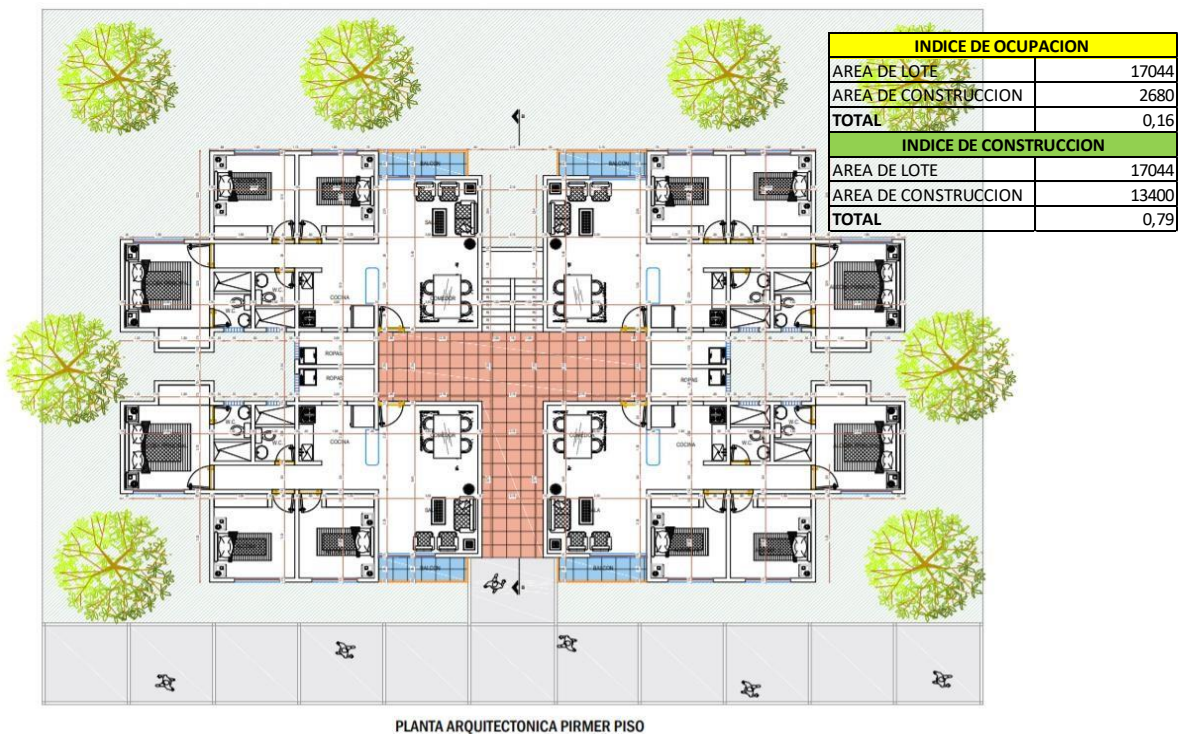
Planta tipo de apartamento. Elaboración Propia.
